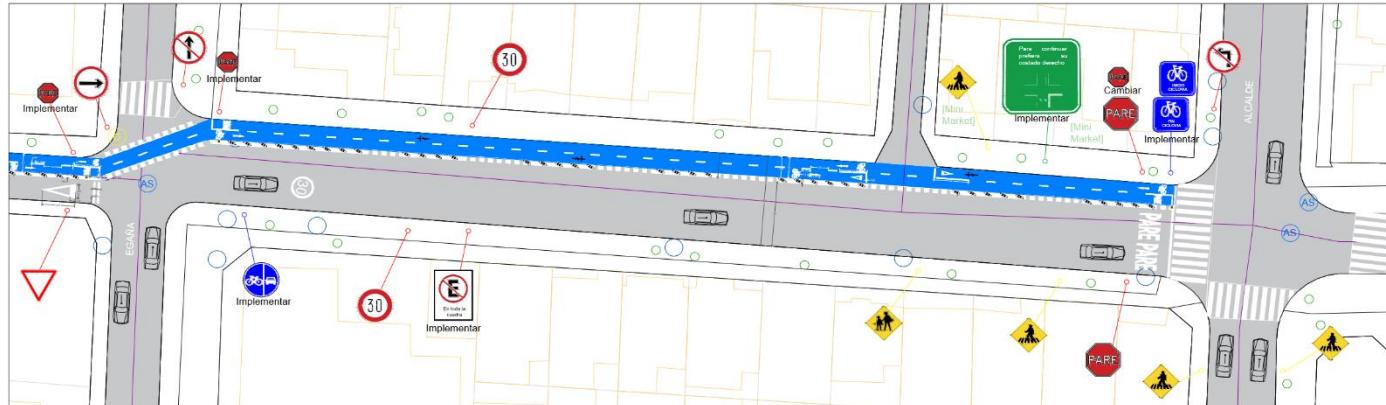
Zoom vista en planta de una cuadra de ciclovía. Elaboración propia.
